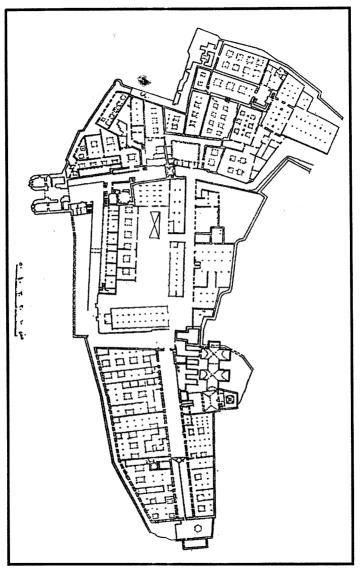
القصر الأحمر - مسقط أفقى للدور الأرضى عن محمود الألفى
